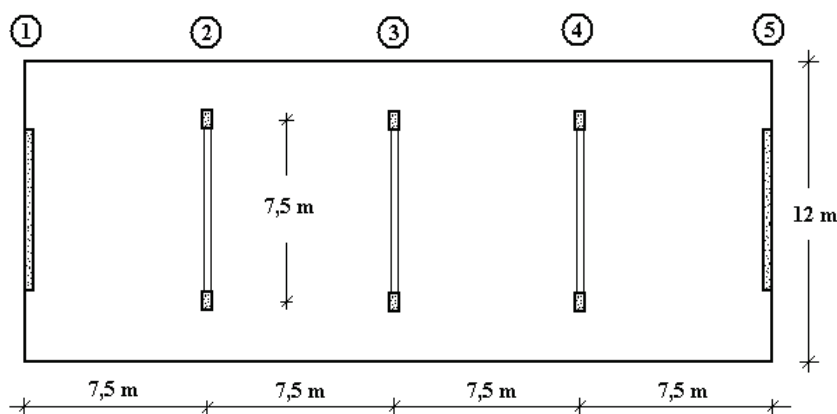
Sistema de contraventamento transversal: exemplos 2, 4, 6 e 8
